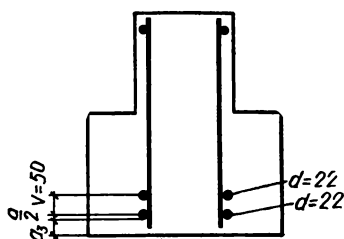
Схема армирования сечения ригеля во втором пролете.
